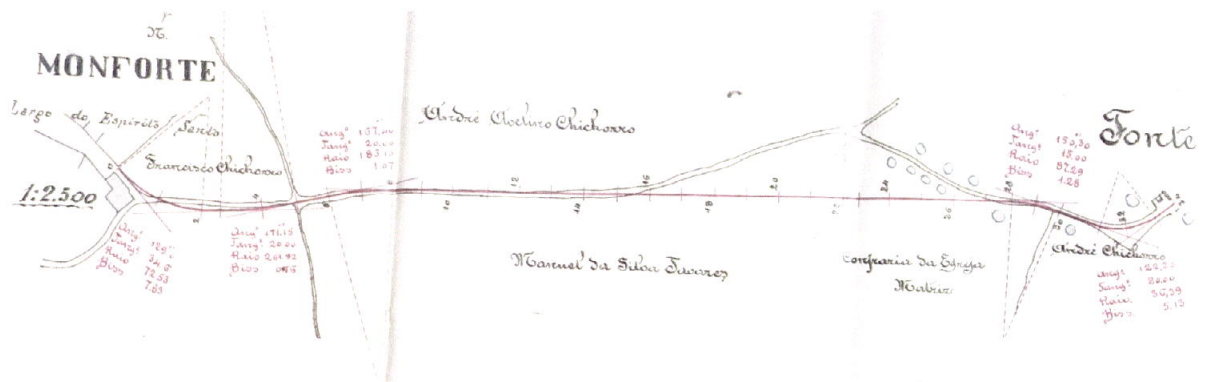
Vista geral do plano de construção do caminho, originalmente à escala 1: 2 500
